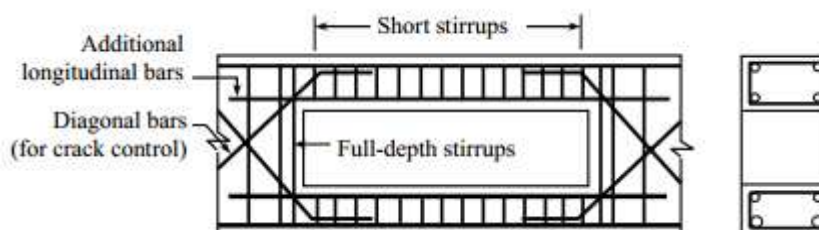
Esquema de armação proposto por Mansur (2006) para zonas com abertura.
